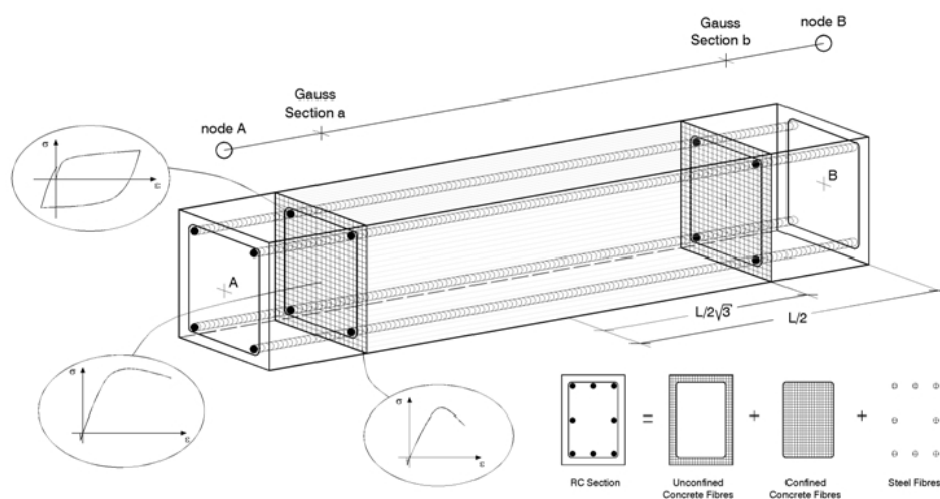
Discretização da secção transversal de um elemento tipo de betão armado
